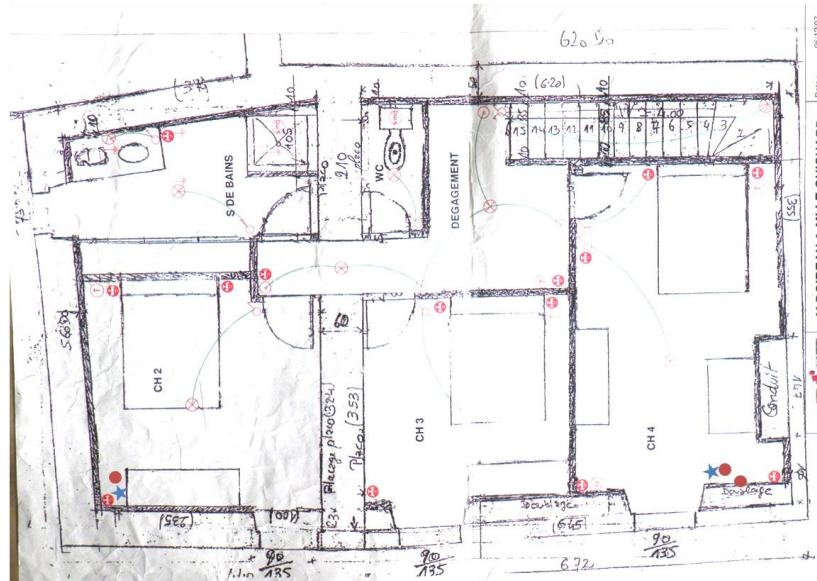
Plan de l'instrumentation du rez-de-chaussée
